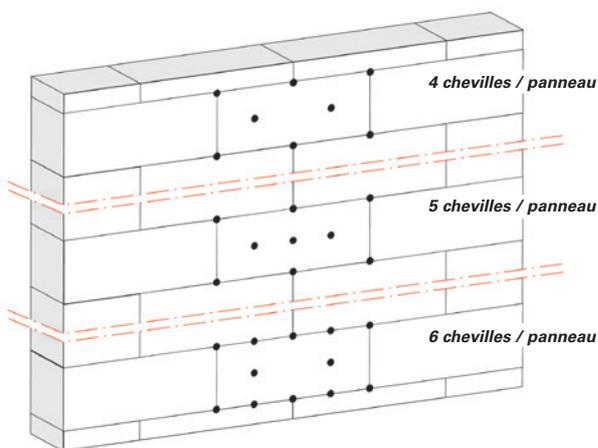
Fixation des panneaux isolants par chevilles – Disposition en joint et en plein (exemples)
